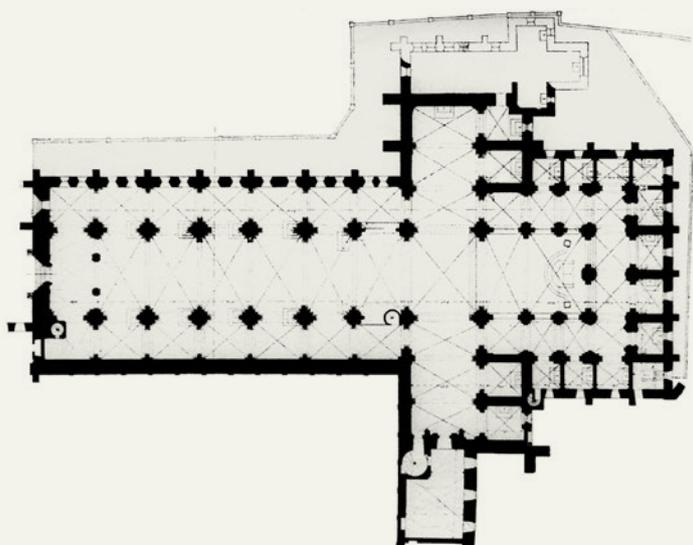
Ehem. Zisterzienserabteikirche Ebrach, Grundriss
